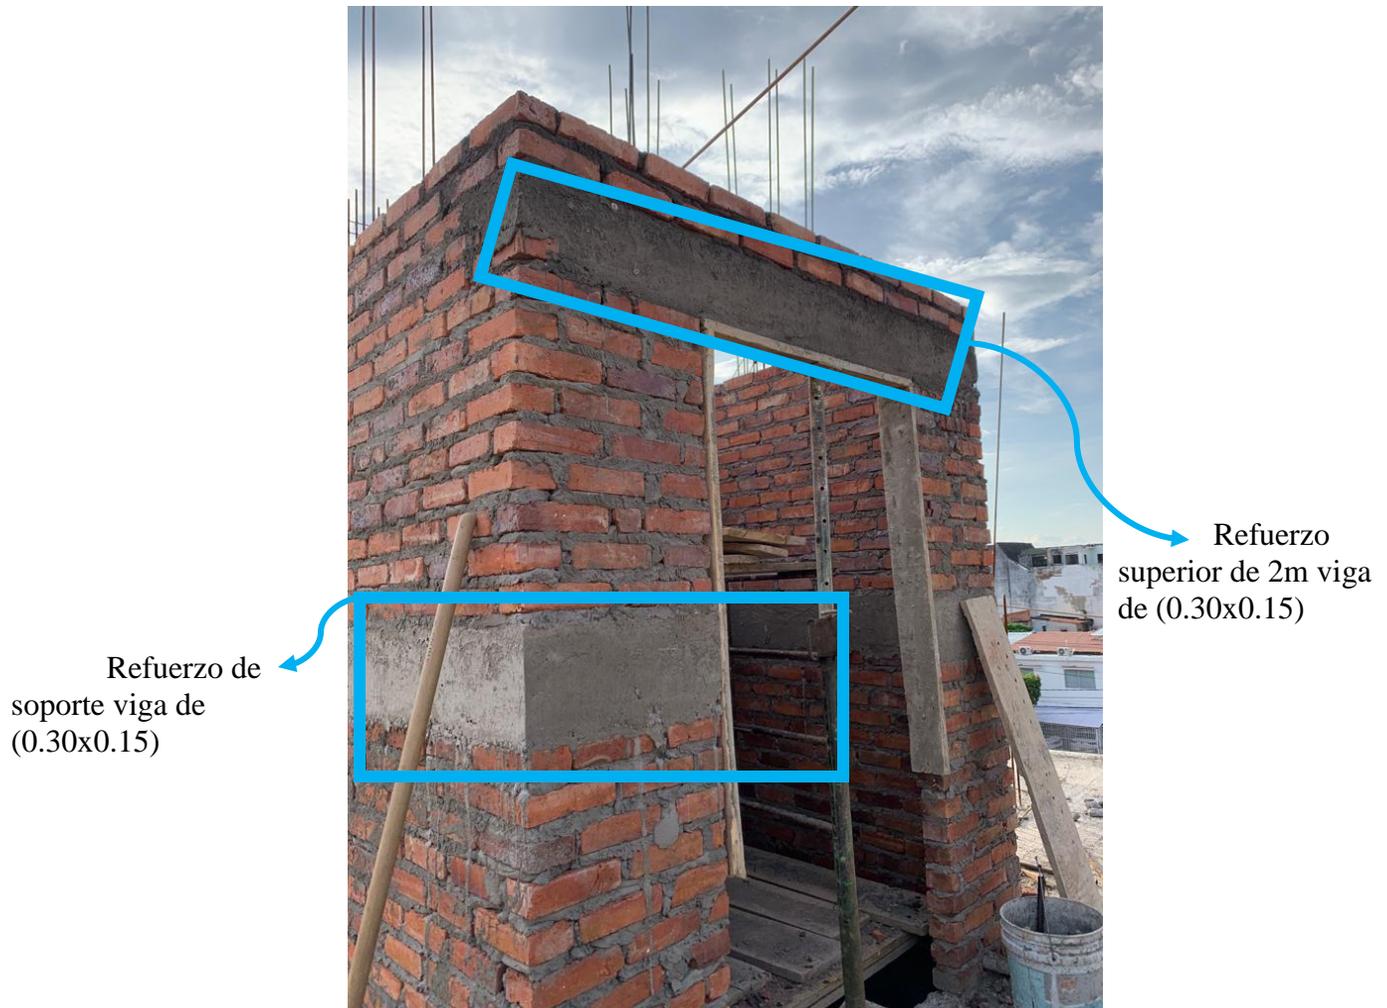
Mampostería de ascensor finalizada nivel 4 con dos refuerzos
